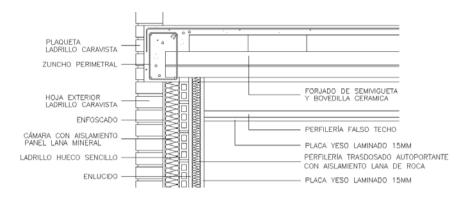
Detalle encuentro fachada - forjado. Fuente propia
